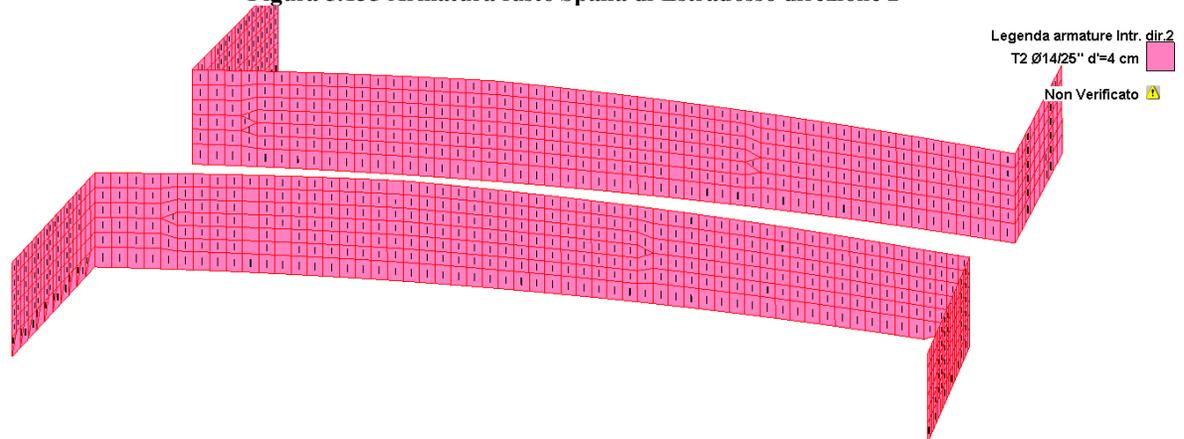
Armatura fusto Spalla di Intradosso direzione 2
